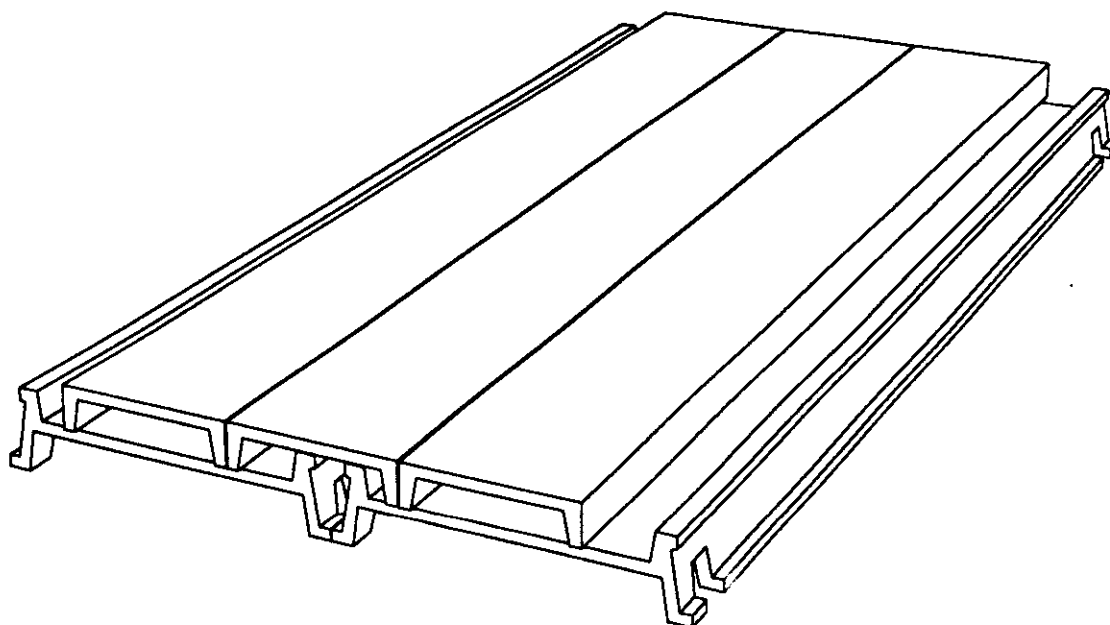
Esquema das placas de piso posicionadas sobre as lajes.
